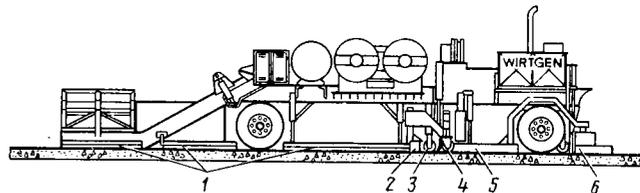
Схема передвижной установки для регенерации асфальтобетонных покрытий:
